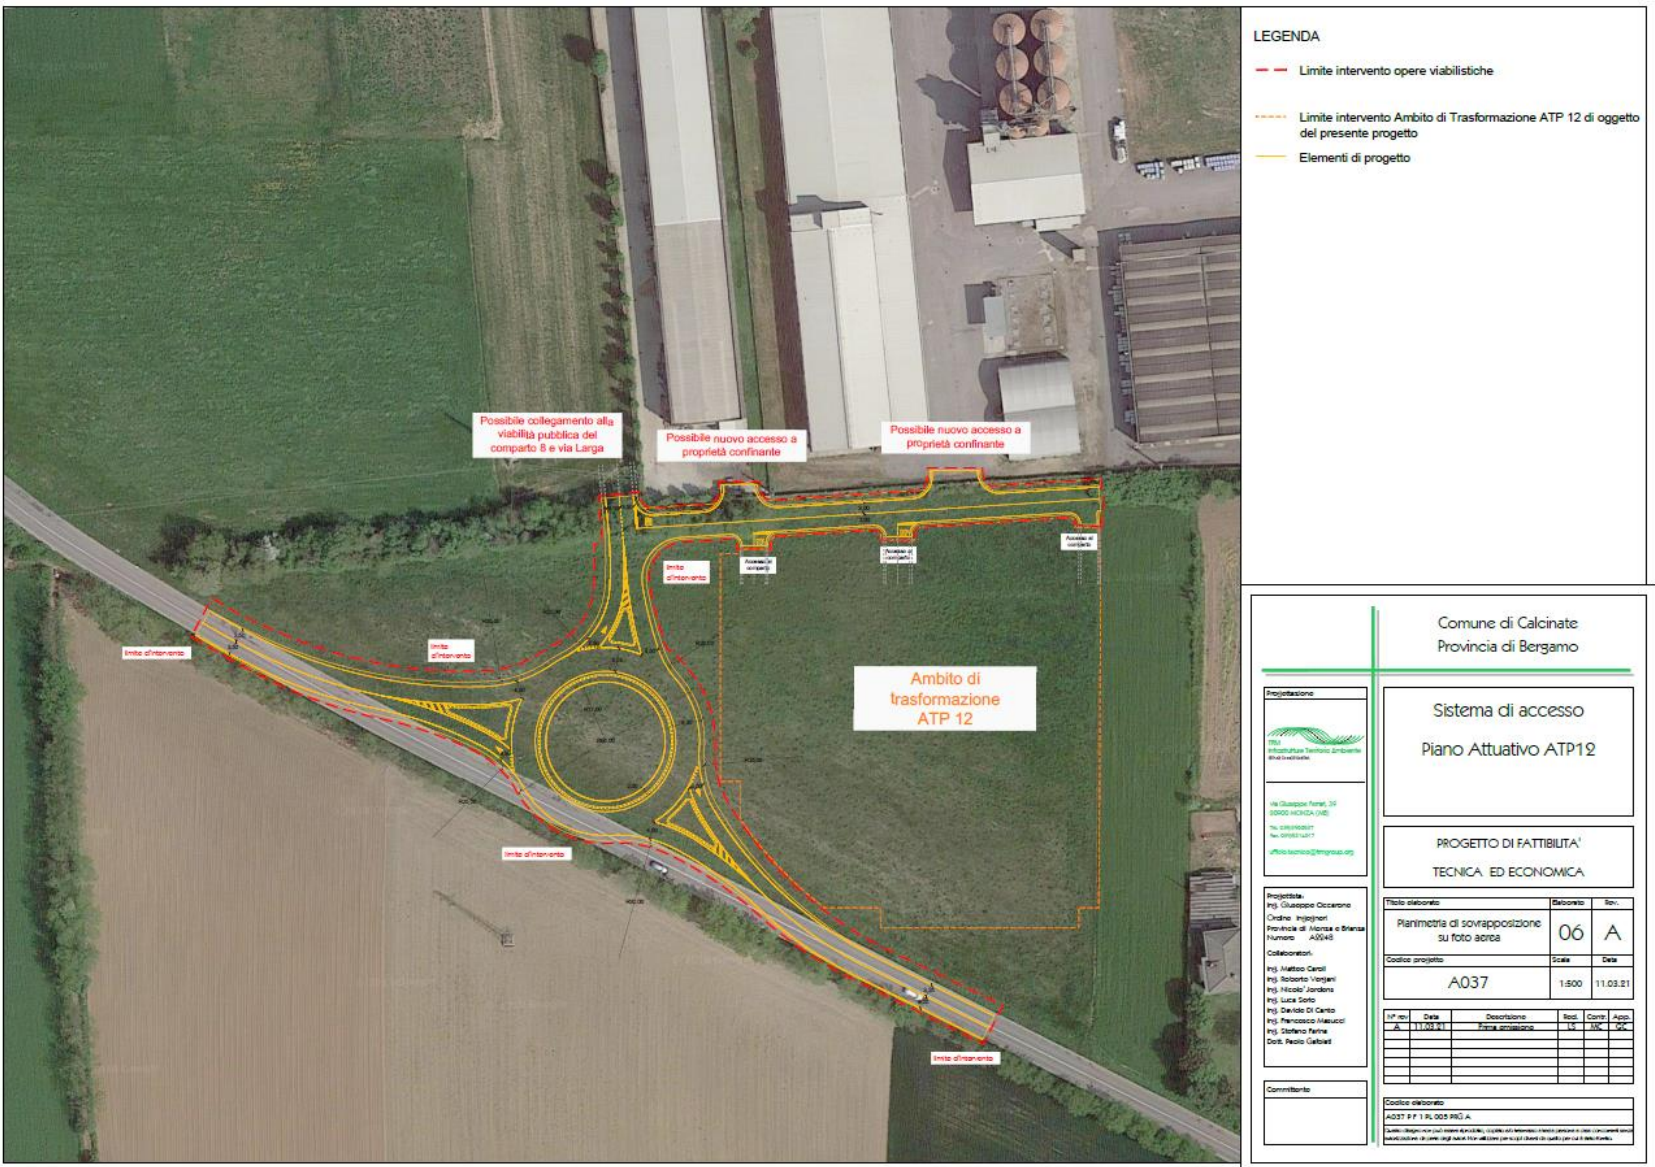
PFTE opere stradali – Planimetria di sovrapposizione su foto aerea
